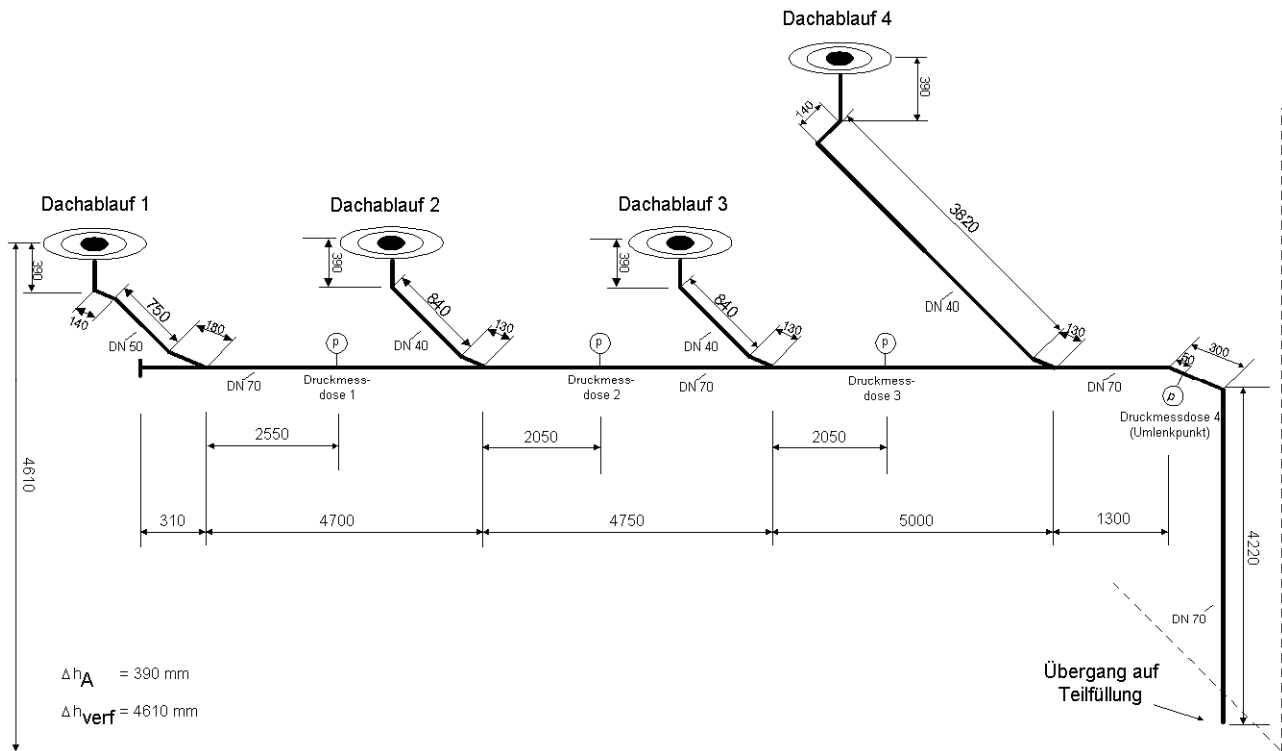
Versuchsanlage mit 4 Dachabläufen
